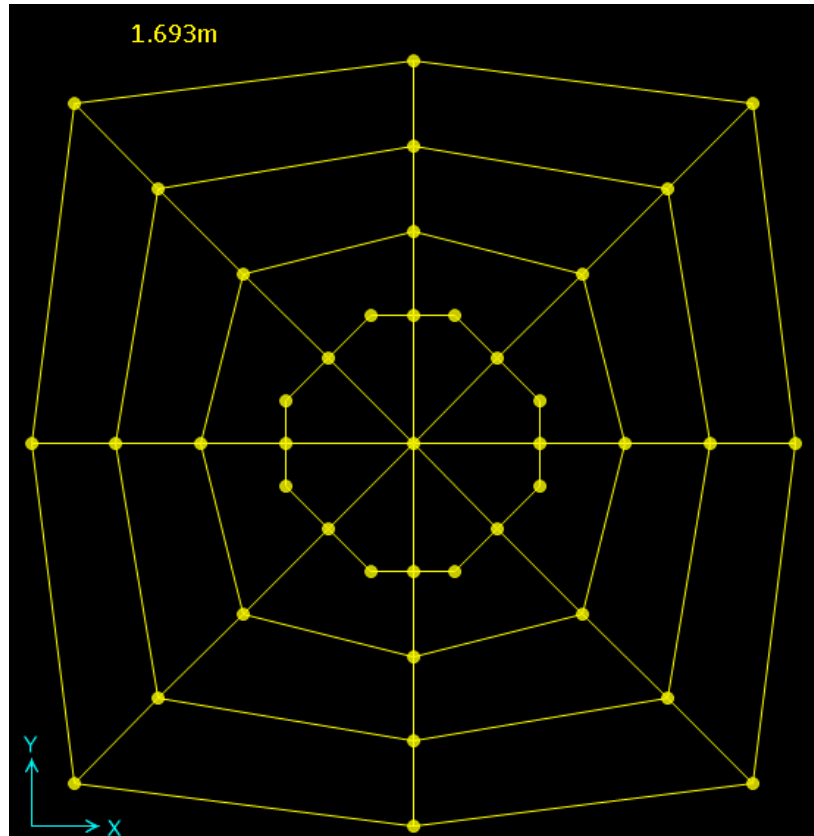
Distancia entre vigas para la distribución de fuerzas.
